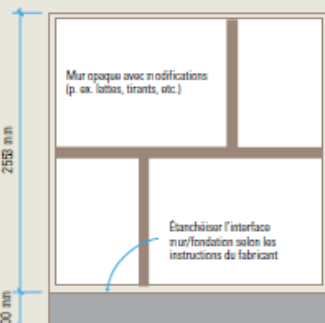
Spécimen 3. Spécimen mural avec joints aux autres éléments du bâtiment, démontrant la continuité du système d'étanchéité à l'air aux interfaces (p. ex. mur opaque et fondation)
